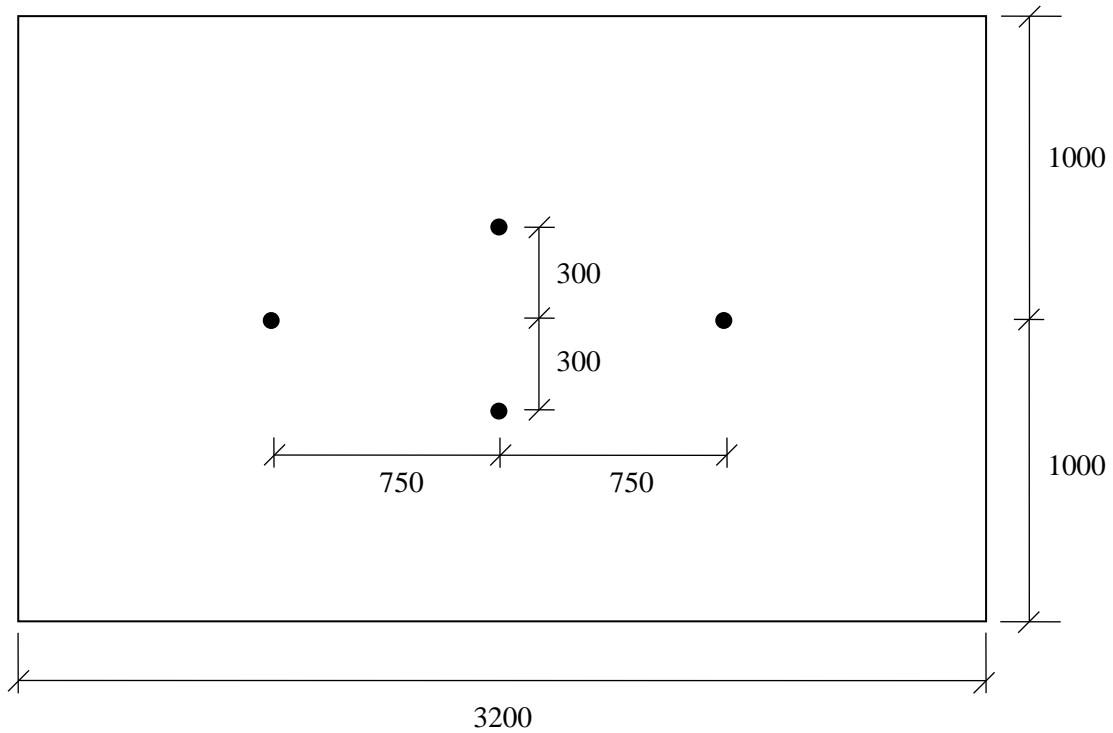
Målepunkter for temperatur i kulvertelementene av konstruksjonsbetong, dimensjoner i mm
